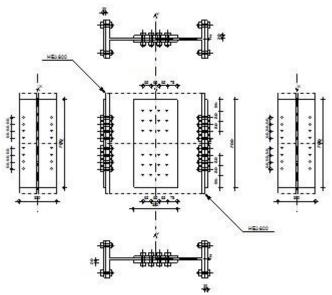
Vérification de l'assemblage poteau-poteau
